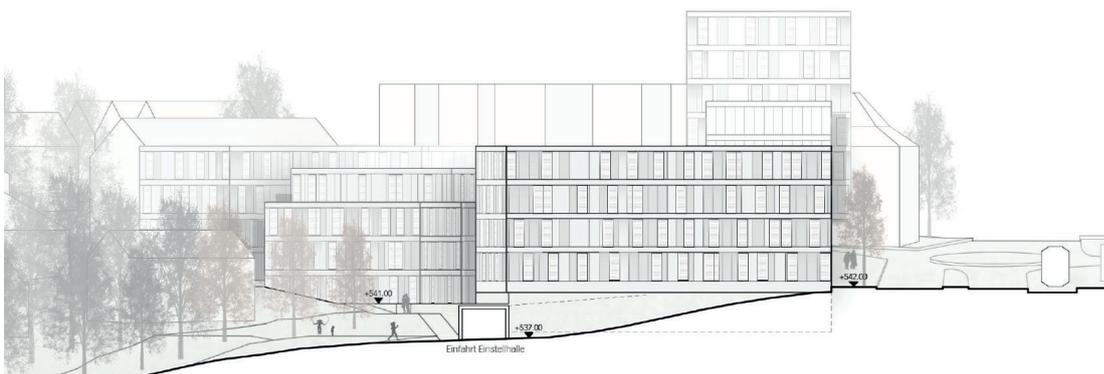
Ansicht aus Süden mit Lage der Einstellhallenzufahrt
